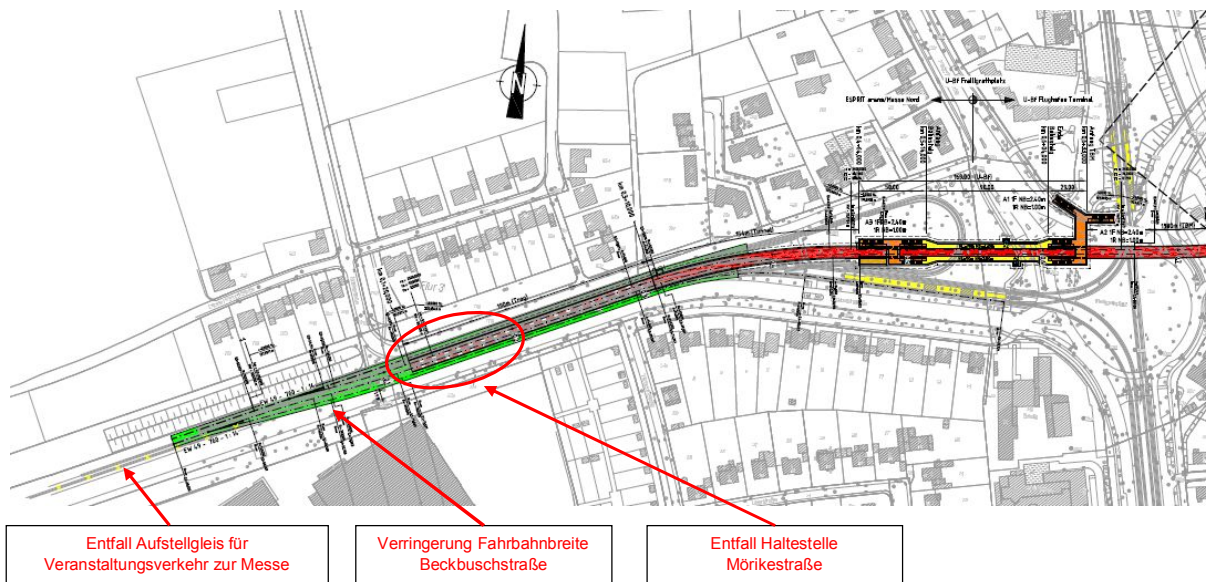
Tunnel Heimat und Bürgerverein, Lageplan Umsteigebahnhof Freiligrathplatz
